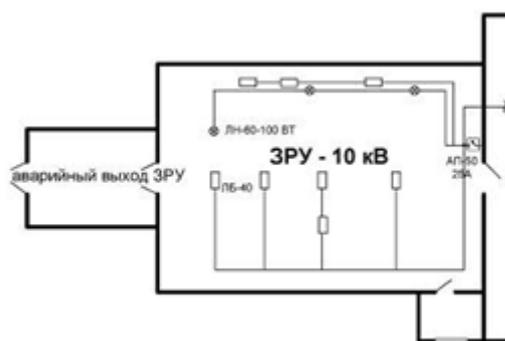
План освещения помещения, существующего ЗРУ 10 кВ
